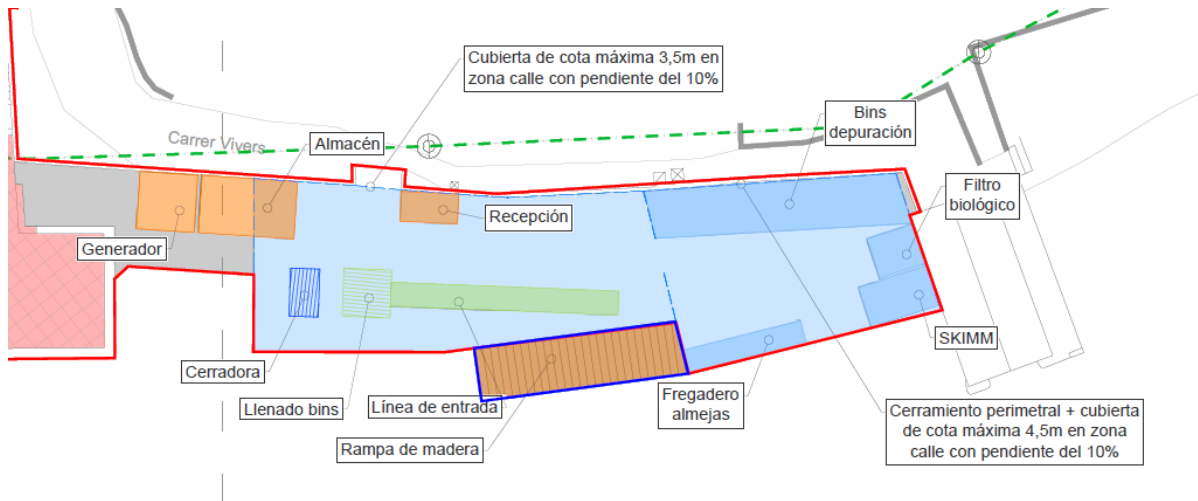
Planta de la solución propuesta en las parcelas 8, 9 y 10.
